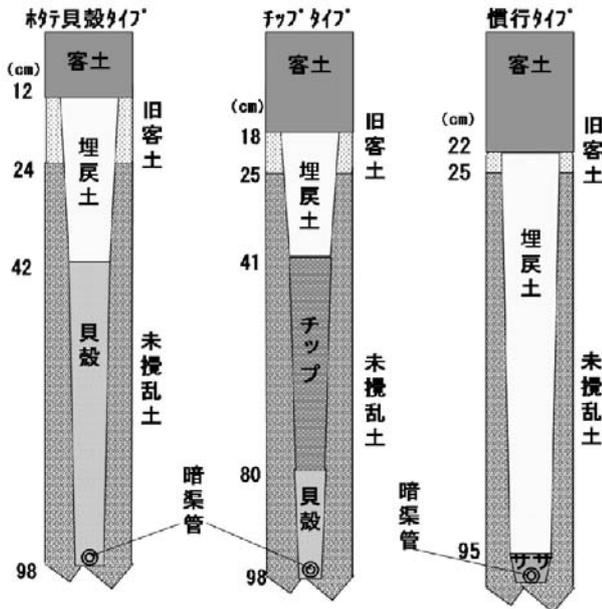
暗渠施工断面図(施工直後<sup>1)</sup>)
